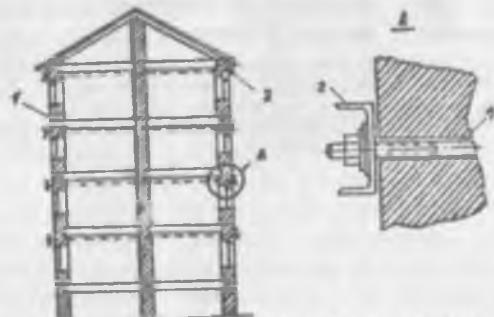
КРЕПЛЕНИЕ КАМЕННЫХ СТЕН НАКАЛАДКАМИ И ТЯНКАМИ
